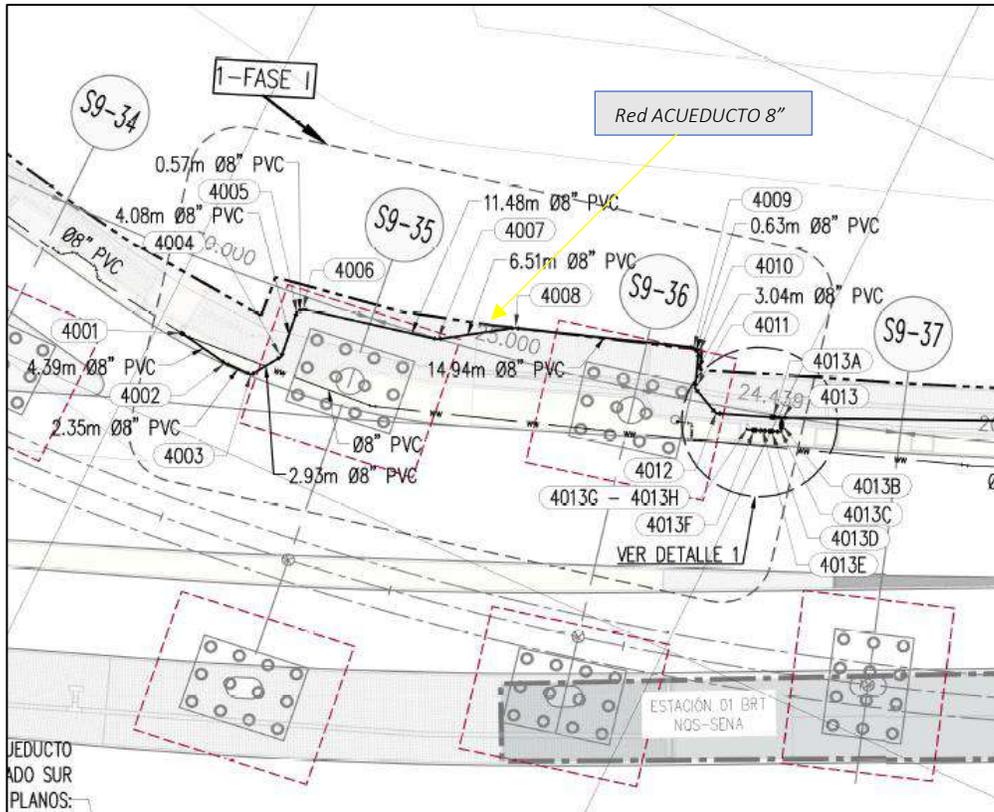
Plano de localización general de la red ACU 4-01
